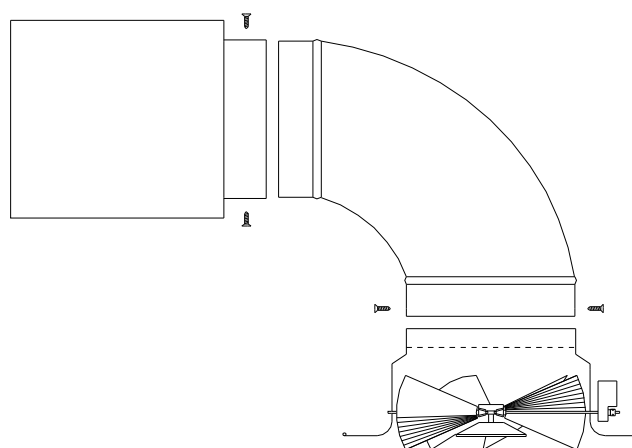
Montaż ze skrzynką rozprężną, wariant z panelem 595x595 mm.
